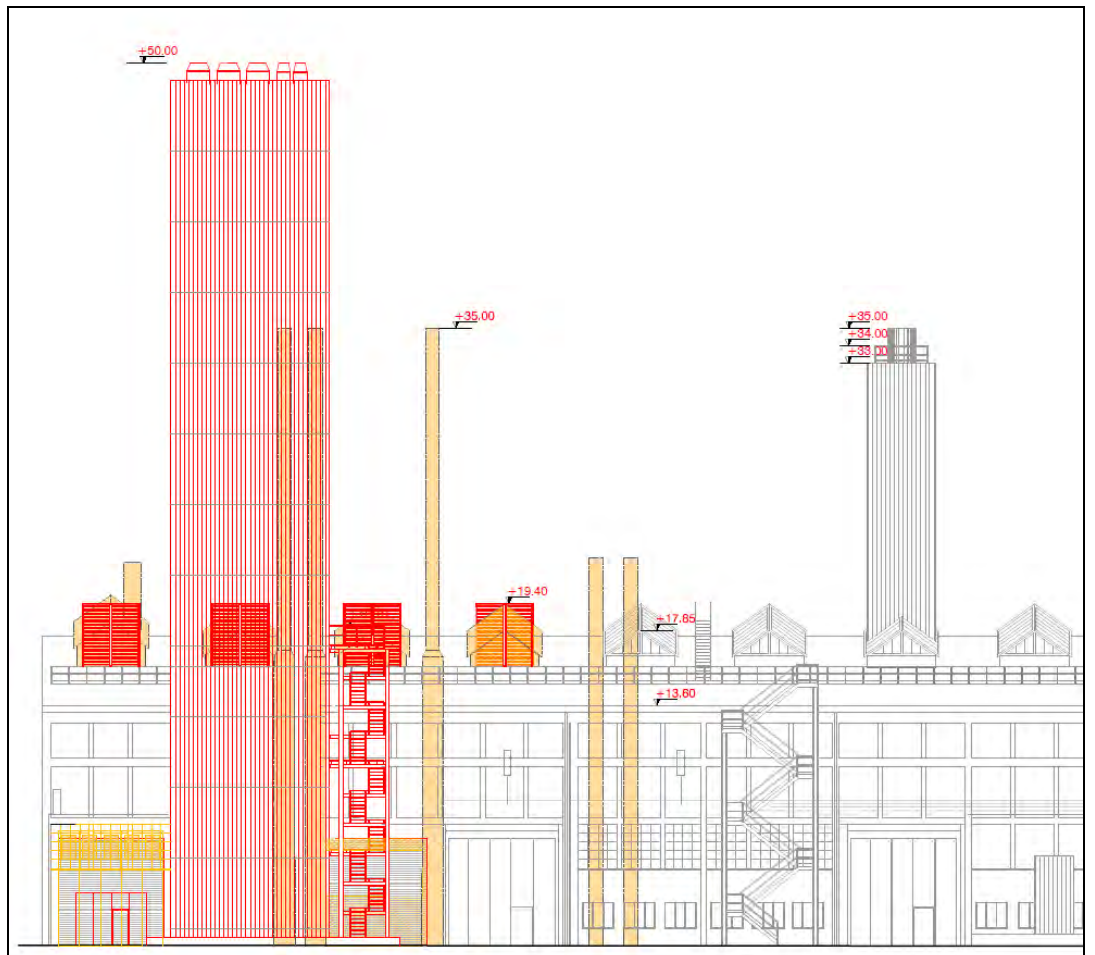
Estratto tav 03 – Progetto definitivo: prospetto est (confronto - particolare)
